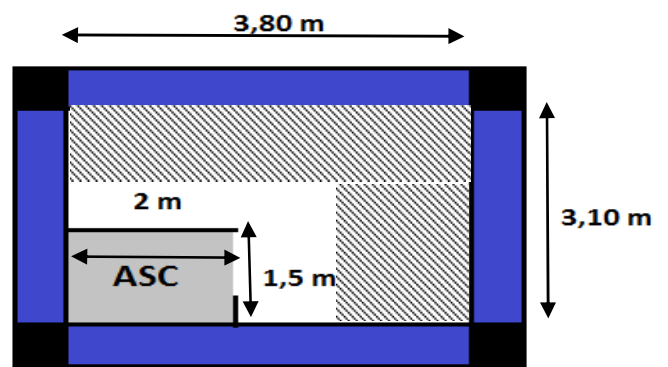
Dalle sur 4 appuis (Ascenseur)
